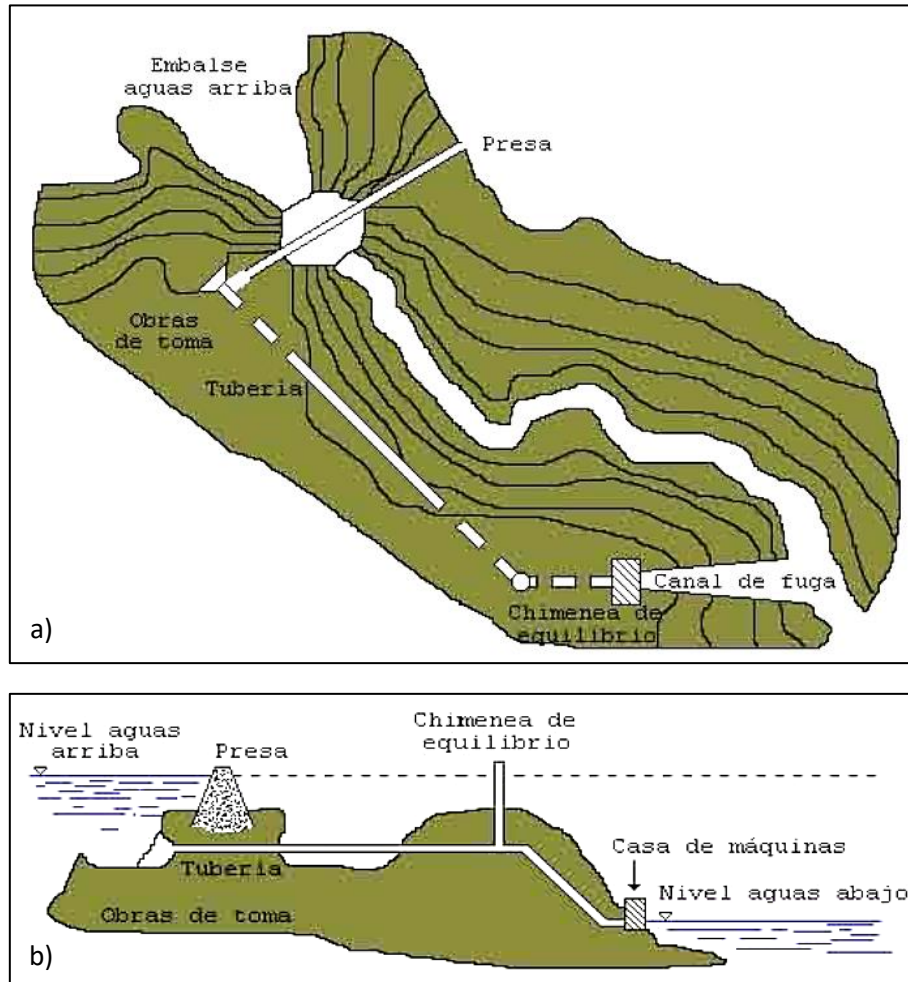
y 10b: Esquema en corte y en planta de una central de montaña.
